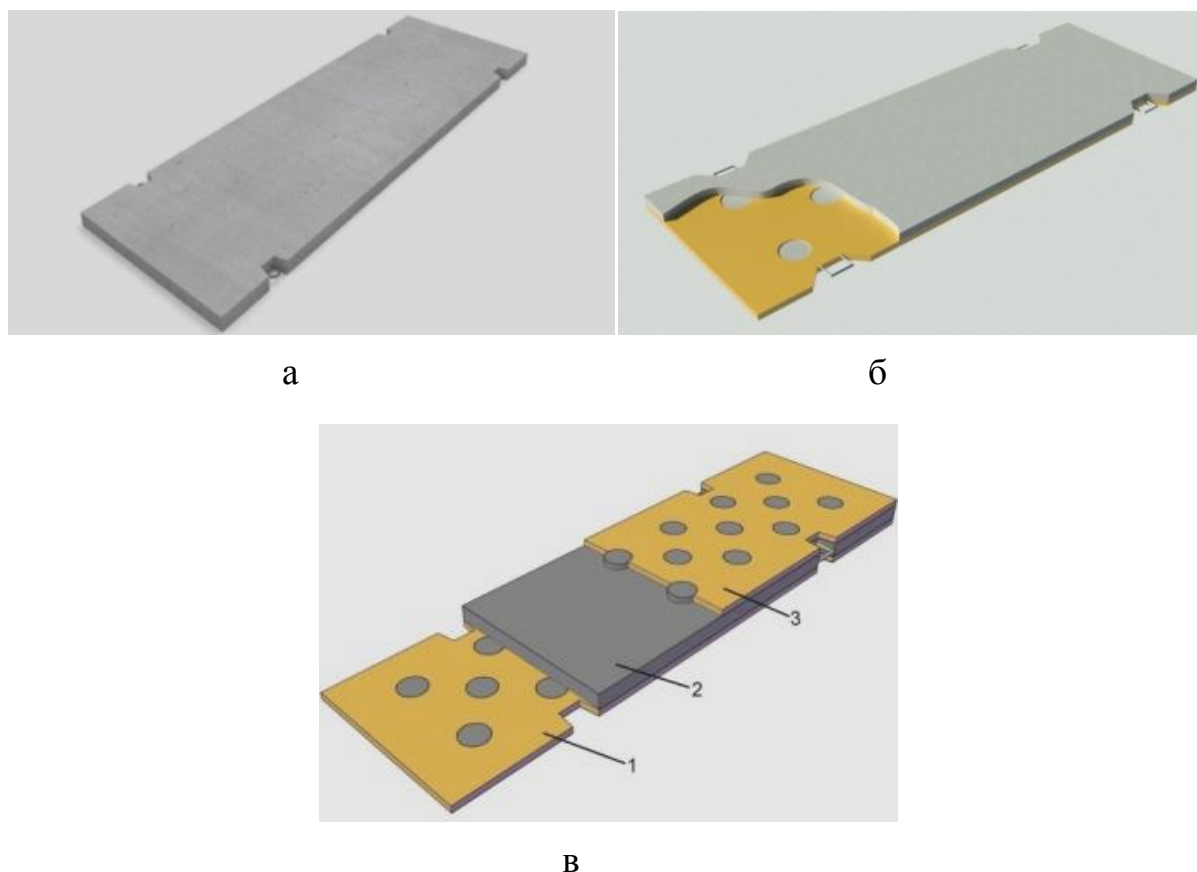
Дорожные плиты: а – однослойная стандартная железобетонная; б – комбинированная сборная двухслойная; в – комбинированная сборная трехслойная: 1 – нижняя полимеркомпозитная плита; 2 – бетонный армированный слой; 3 – верхняя полимеркомпозитная плита
